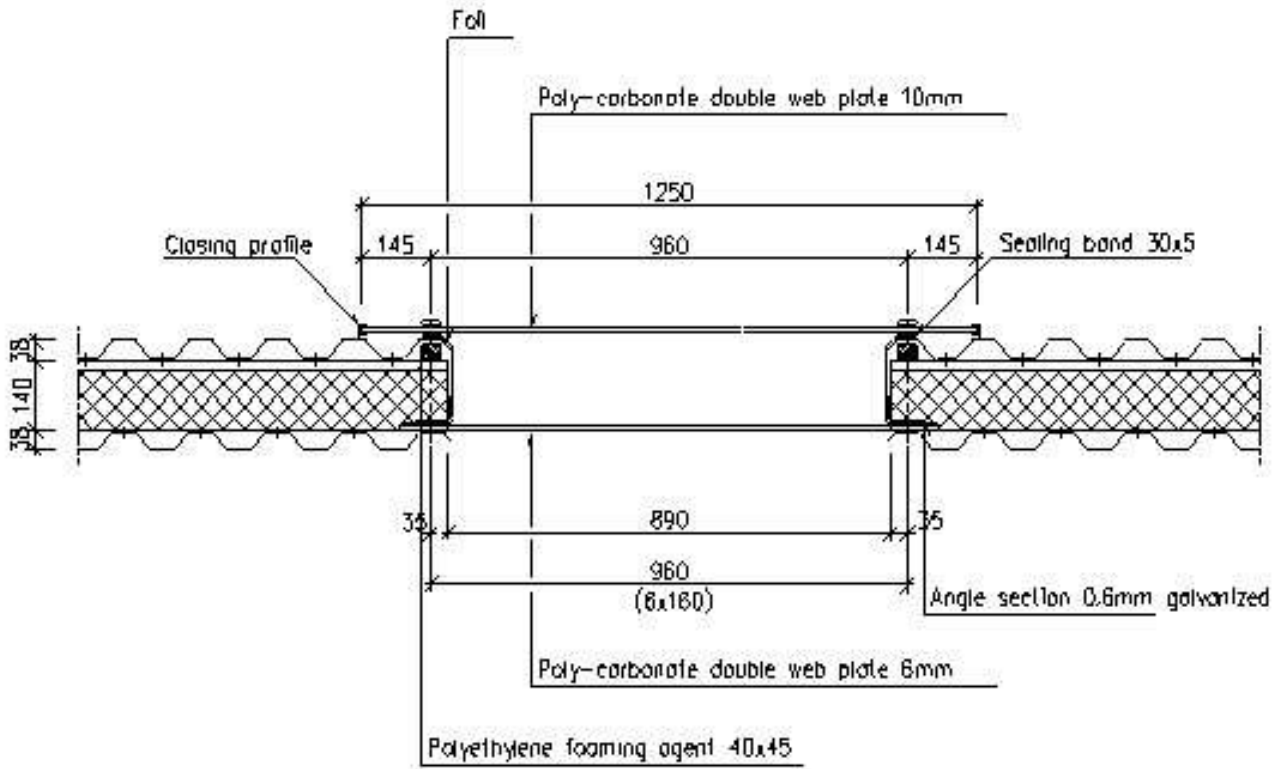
Стандартная крепёжная полоса для двухслойной конструкции
